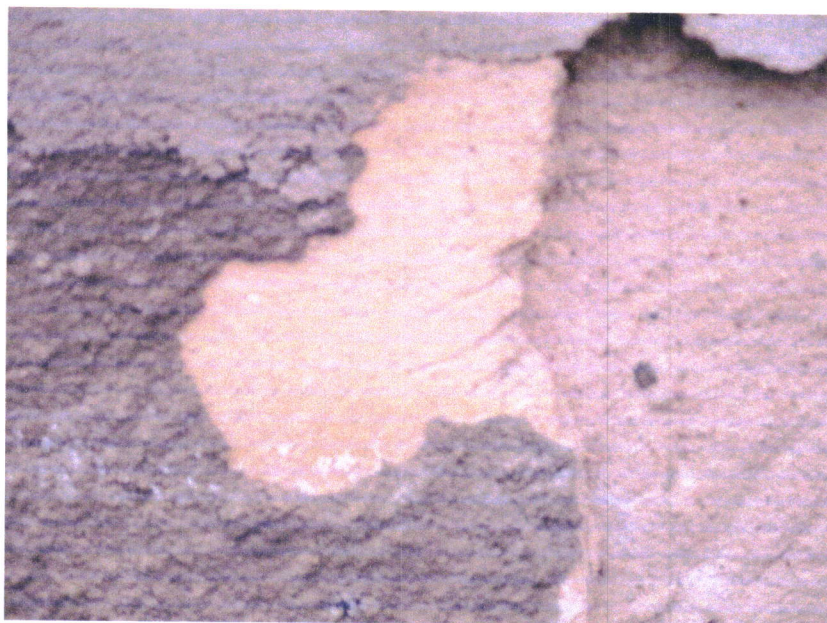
Częściowa odkrywka w celu ustalenia pierwotnego koloru
